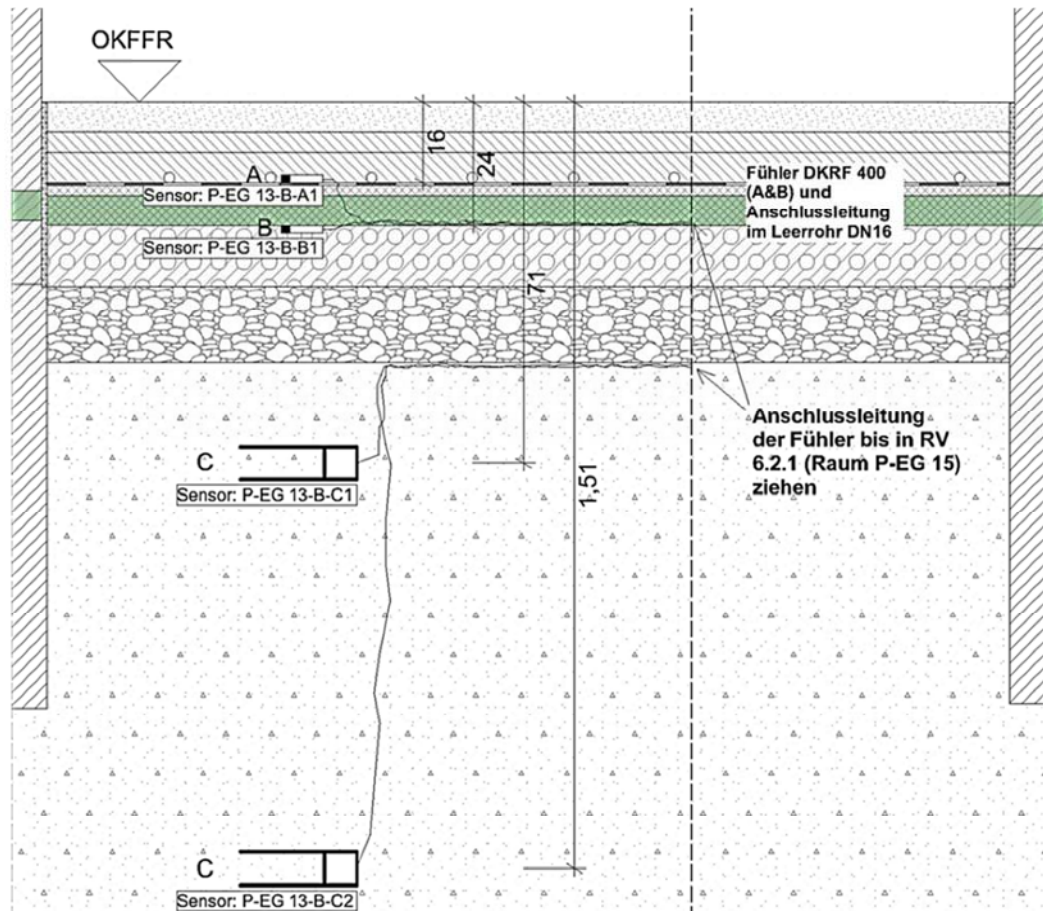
Schnitt durch den Fußbodenaufbau Porenbeton mit Zement-Estrich mit den verorteten Klimamesspunkten
